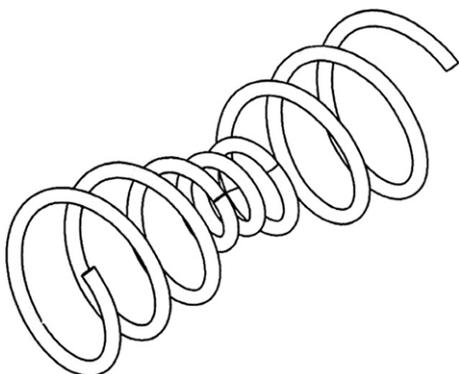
Спираль для армирования железобетонного подрельсового основания в зоне установки дюбеля [8]
